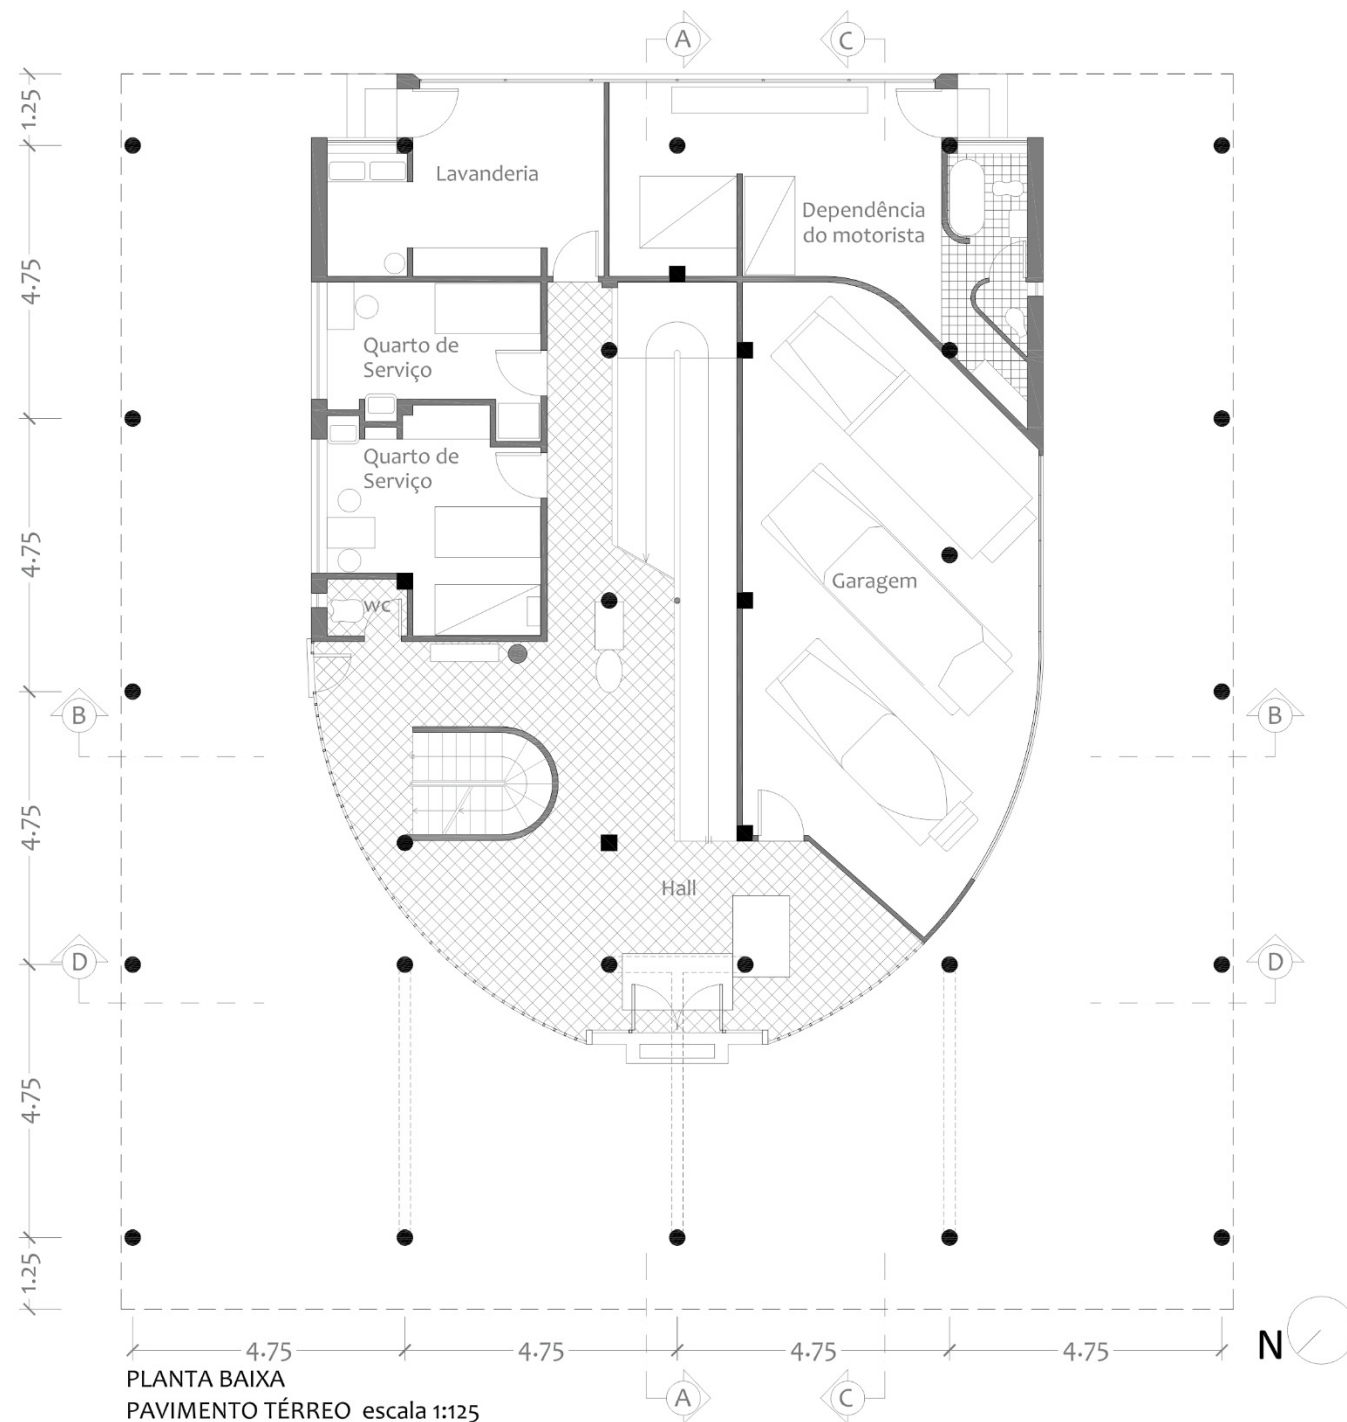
Vila Savoye, projeto construído. Planta baixa do térreo
